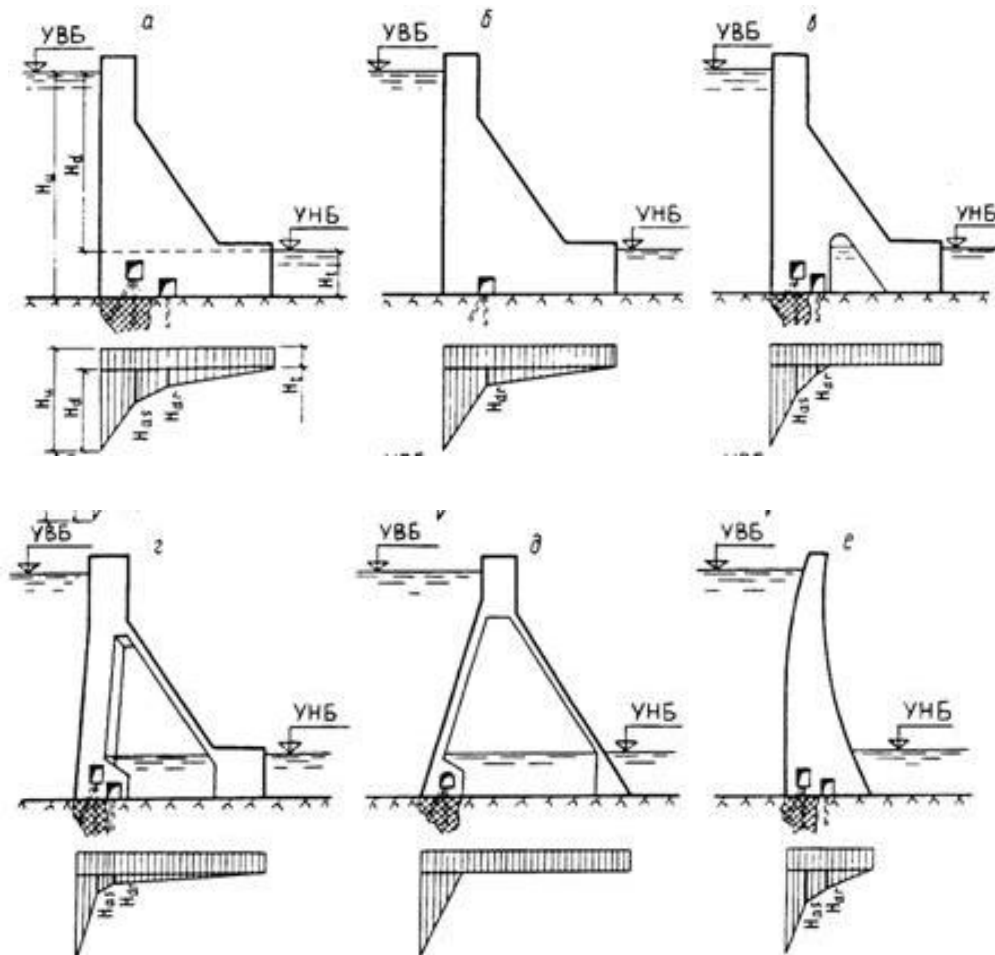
Эпюры пьезометрического напора по подошве плотины
